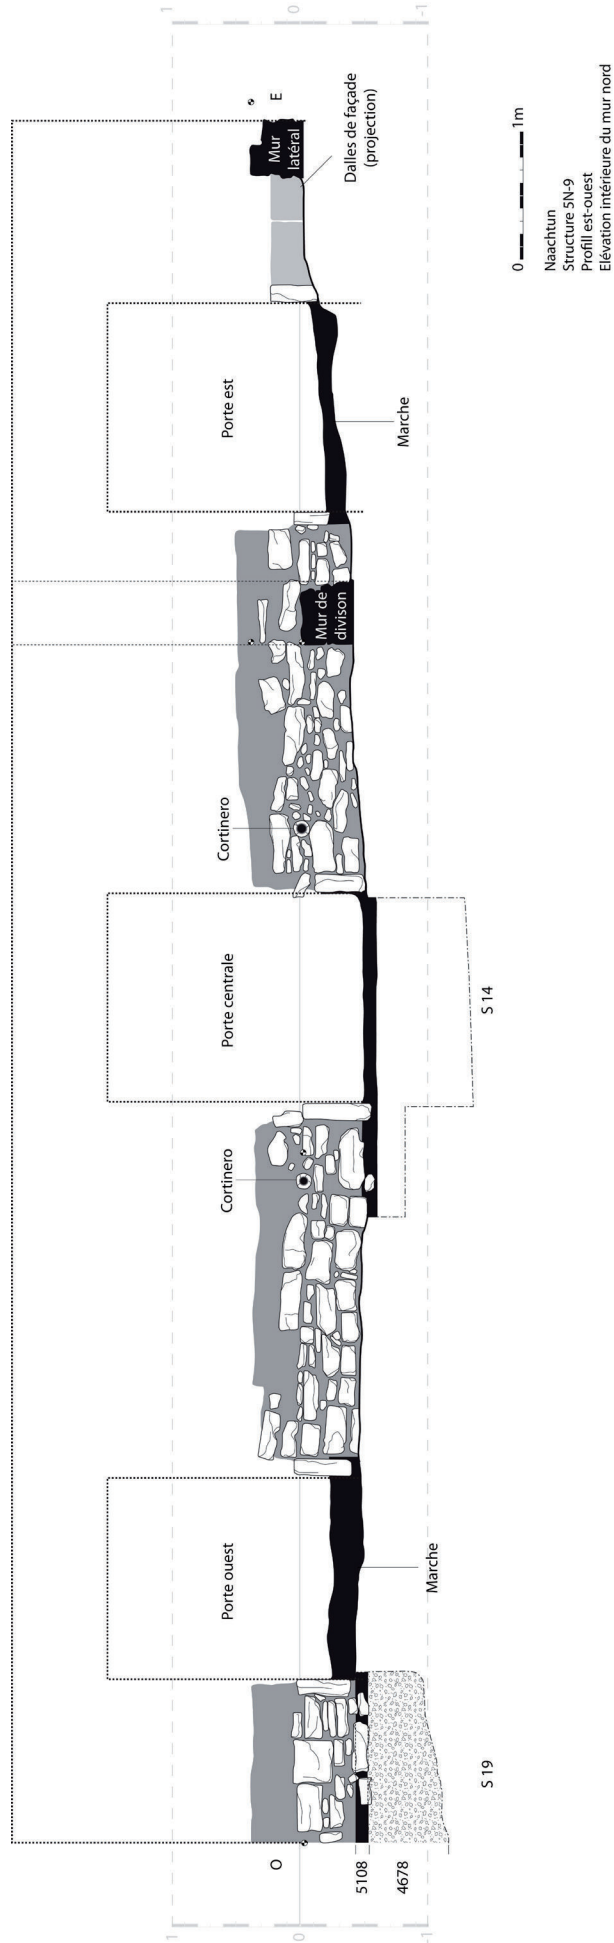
Élévation interne du mur nord de 5N-9. Les deux hautes marches dans l'encadrement des portes est et ouest restreignent drastique-
